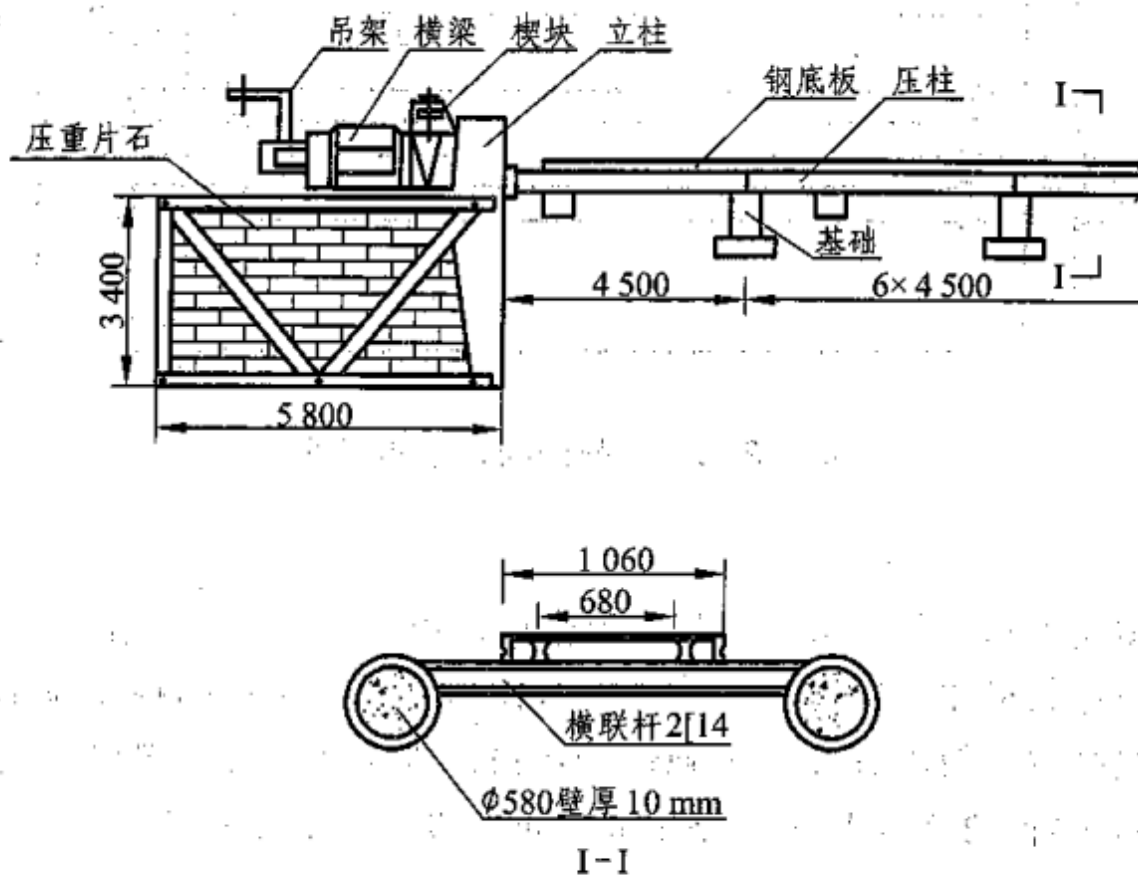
拼装式钢管混凝土台座 (单位: cm)
